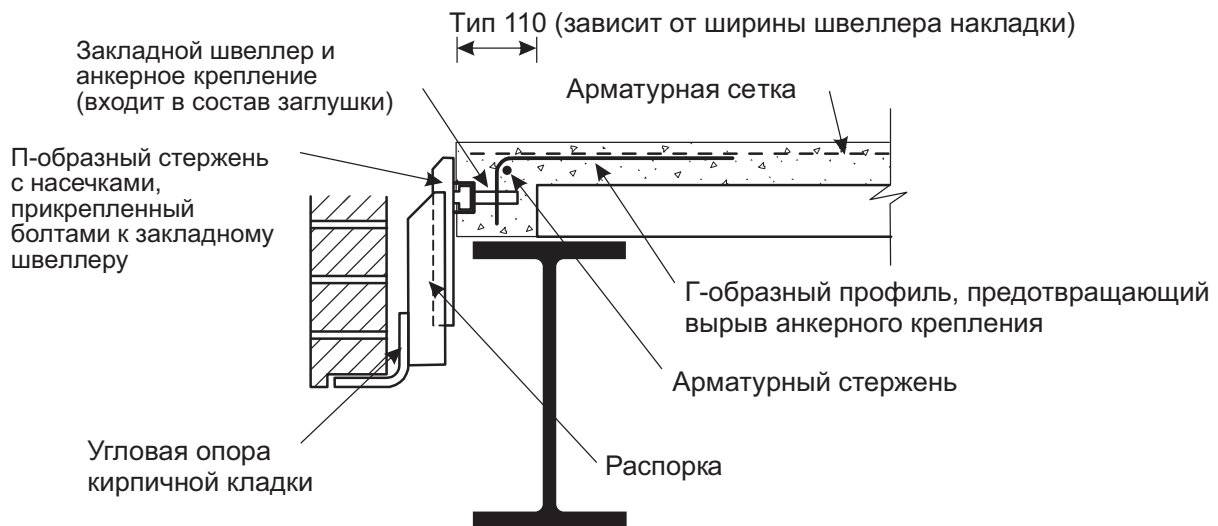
Типовая конструкция для крепления кирпичной кладки
